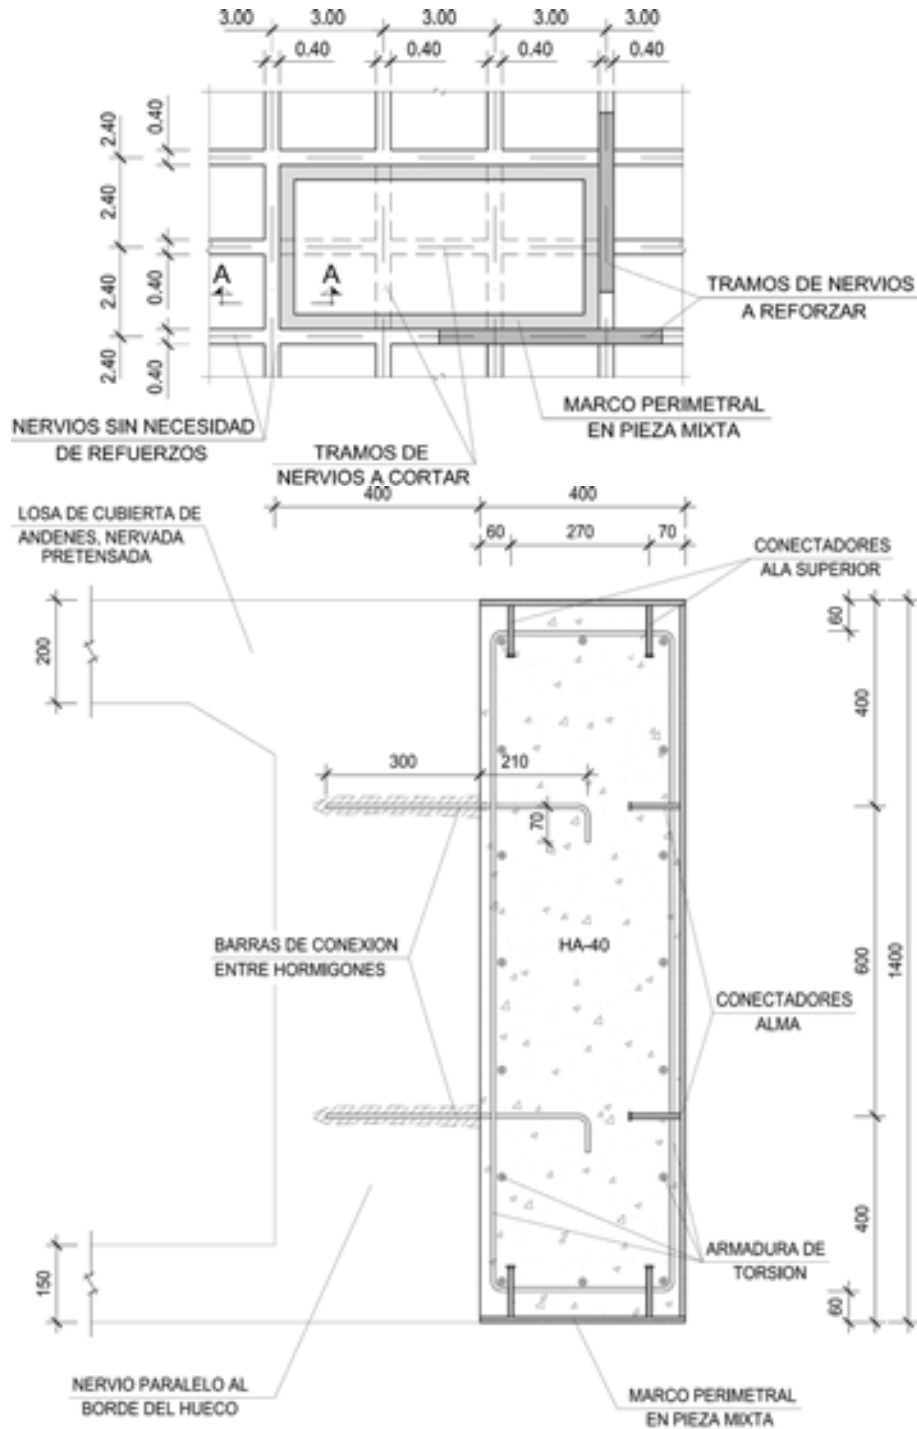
Marco perimetral mixto (planta y sección tipo)
